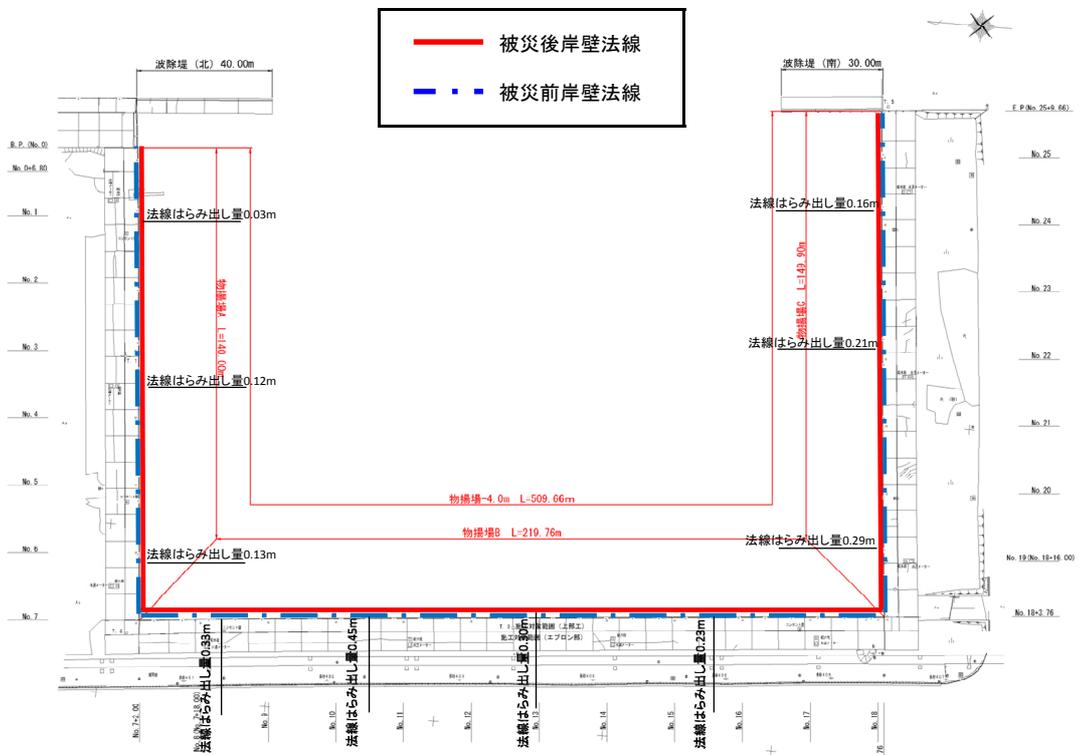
No.19 常陸那珂港区_北ふ頭地区物揚場 A,B,C の平面図 (被災後)
